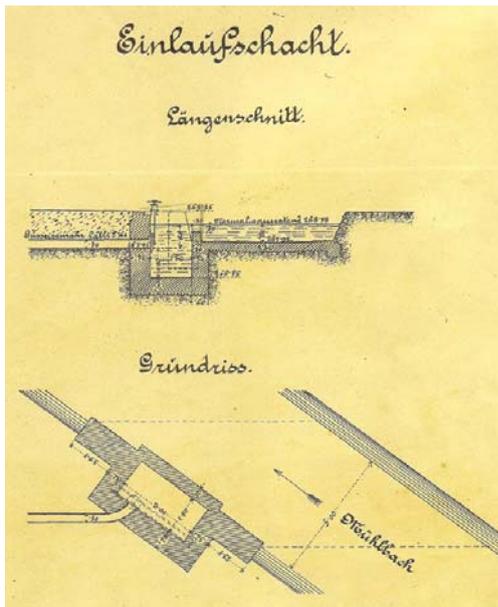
Einlaufschacht, Ausführungsplan 1904
